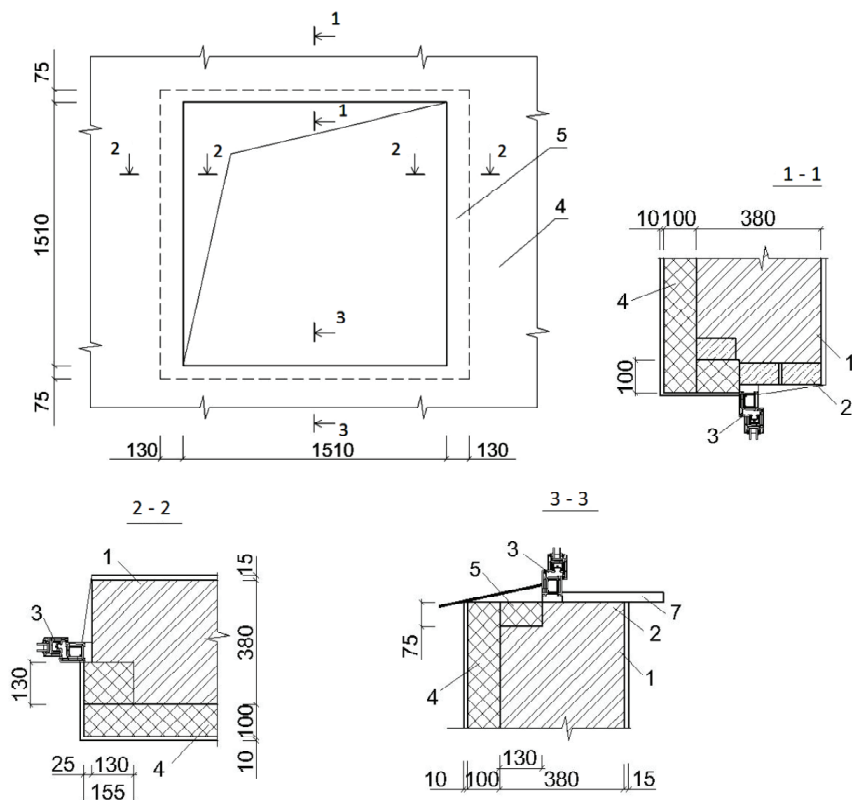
Конструктивное решение оконного проема с углублением в стене: 1 — наружная стена, 2 — железобетонная перемычка, 3 — оконное заполнение, 4 — внешняя теплоизоляция, 5 — дополнительный слой утеплителя в углублении проема, 6 — слив, 7 — подоконник.
